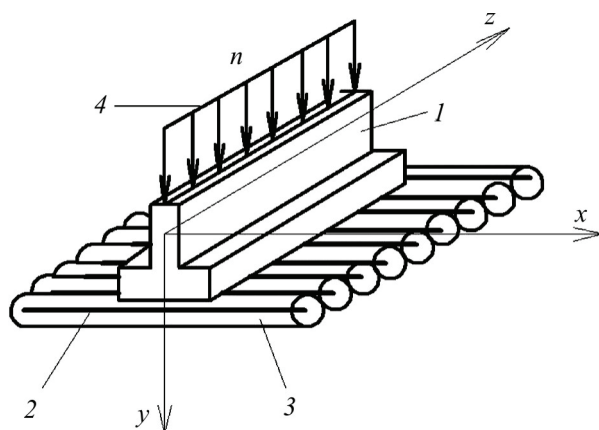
Реальная схема закрепления основания фундамента геоимплантатной конструкцией: 1 – ленточный фундамент; 2 – геоимплантат; 3 – зона уплотнения грунта вокруг армозлемента; 4 – распределенная нагрузка на фундамент
